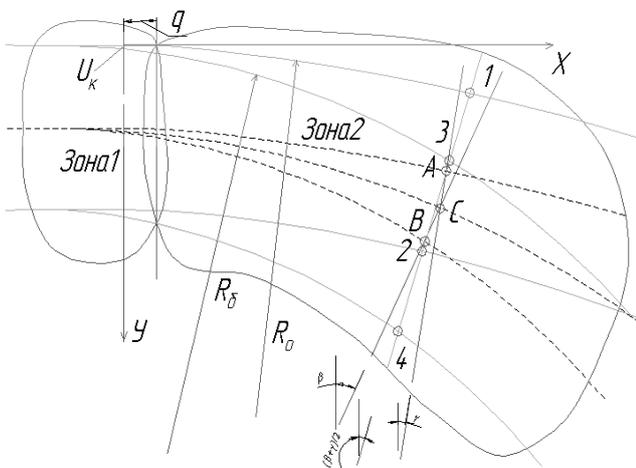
Схема к расчету укладки железобетонных брусьев в криволинейных стрелочных переводах
